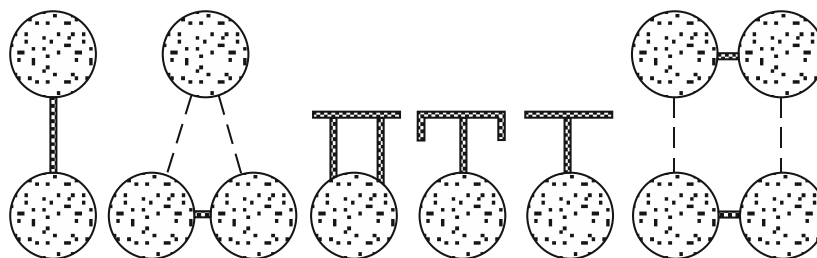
Примеры составных сечений колонн с трубобетонными ветвями [2]
